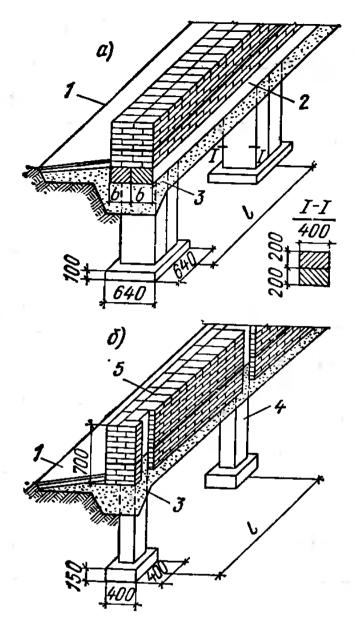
Столбчатые железобетонные сборные фундаменты под стены:
